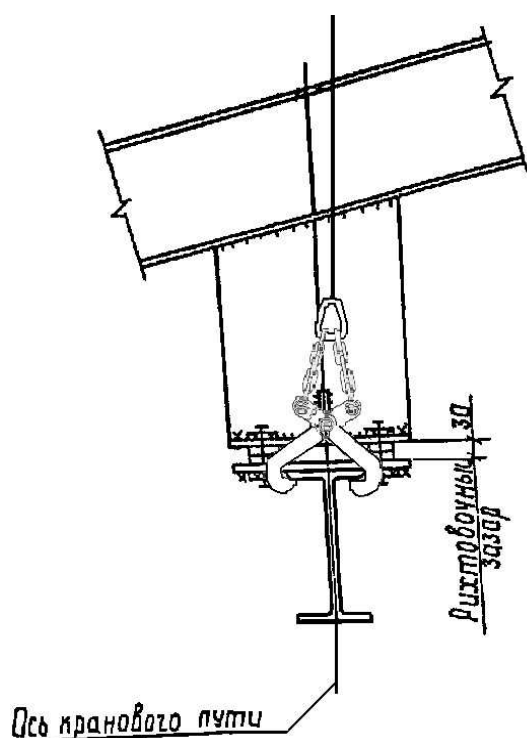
Монтаж подкрановой балки клещевыми грузозахватными приспособлениями
